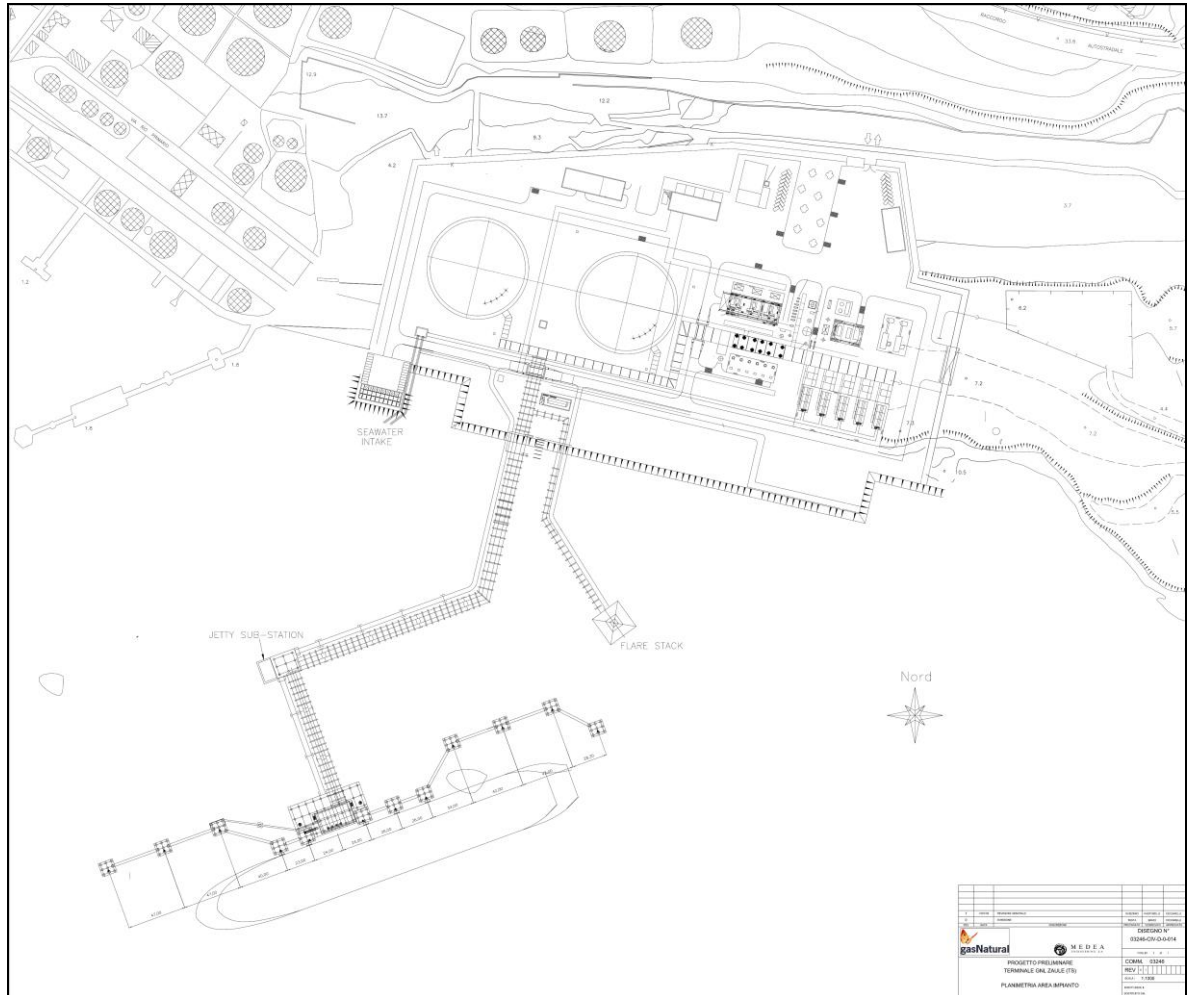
PLANIMETRIA DELL' AREA DI IMPIANTO DEL TERMINAL GNL
